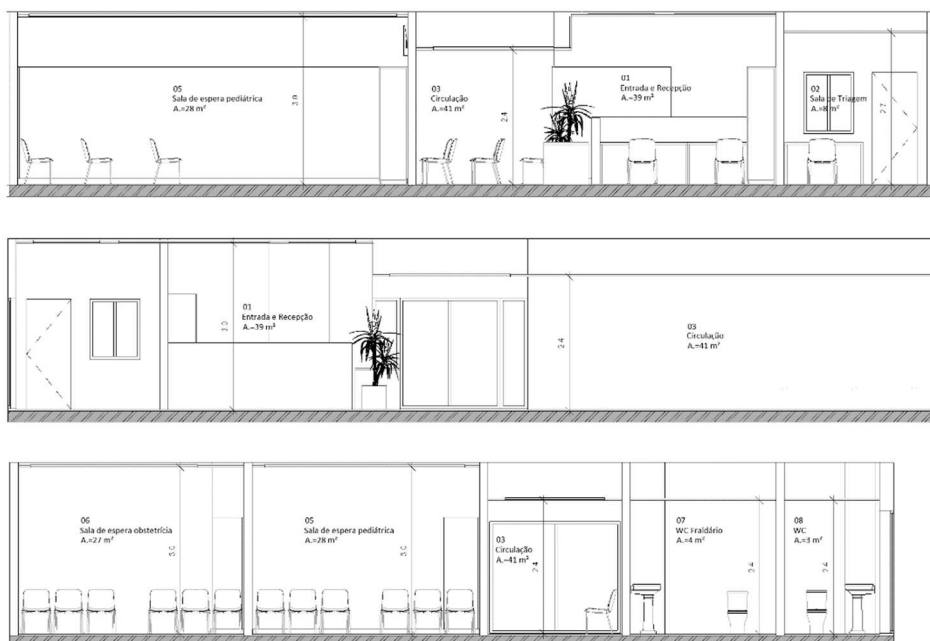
Cortes A, B e C de Arquitetura Existente. Fonte: Autora
